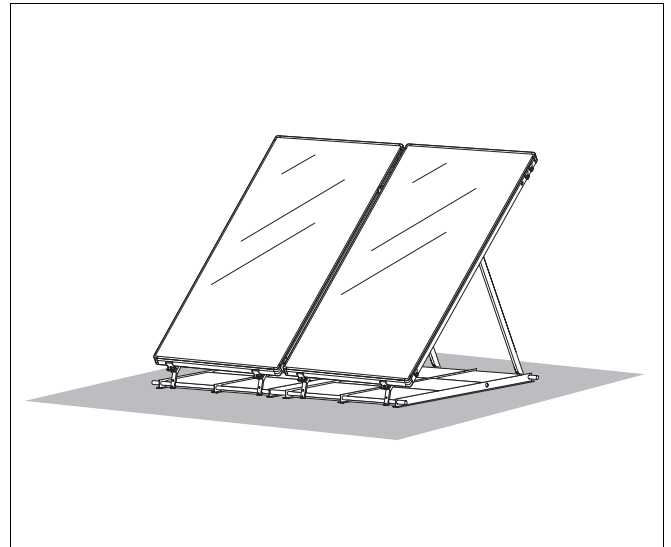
Platzbedarf Kollektorfeld – senkrechte Ausführung
